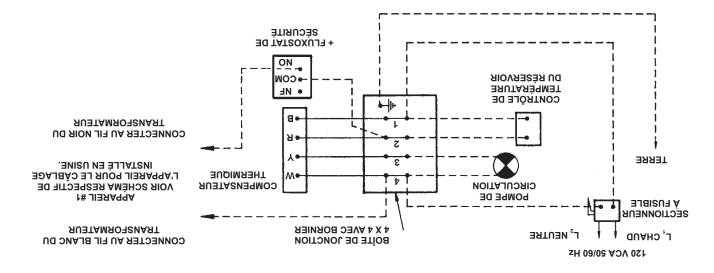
CER - TEMP 80 - INSTALLATION 1 APPAREIL - POUR APPLICATION D'ALIMENTATION EN EAU CHAUDE
